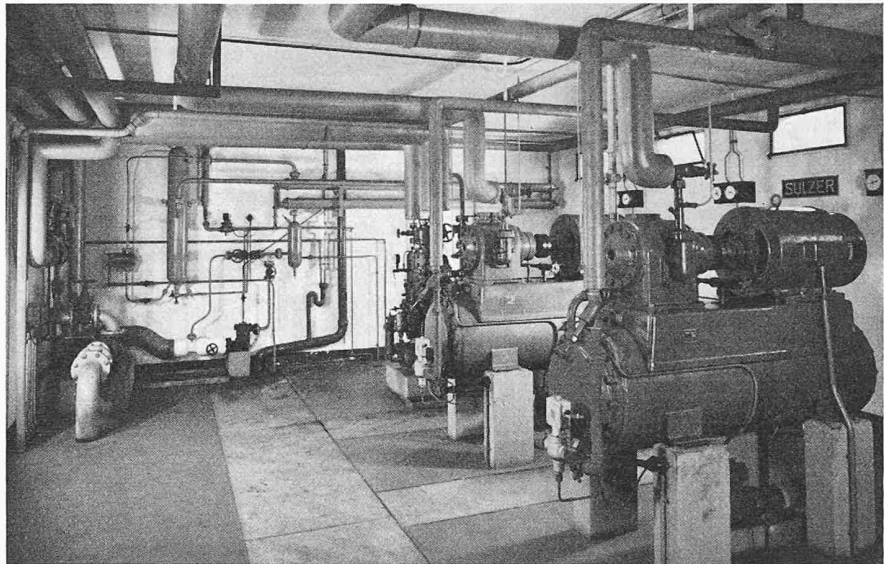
Maschinenraum. Rechts vorn die beiden Rotationskompressoren, dahinter der Kolbenkompressor, an der Rückwand die Apparate für die Gefrieranlage, links die Abtau-Wasserpumpe
